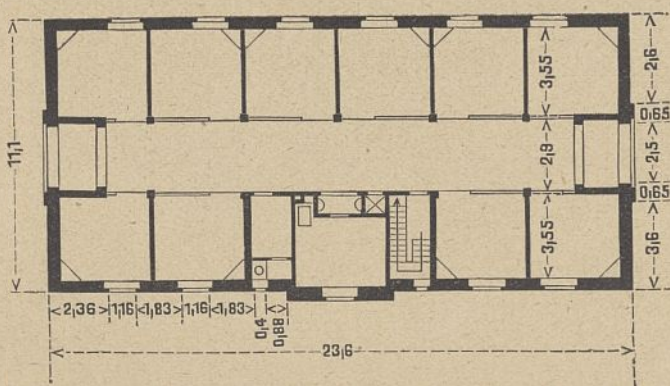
Altefeld, Boxenstall für fremde Stuten. M. 1:300.
